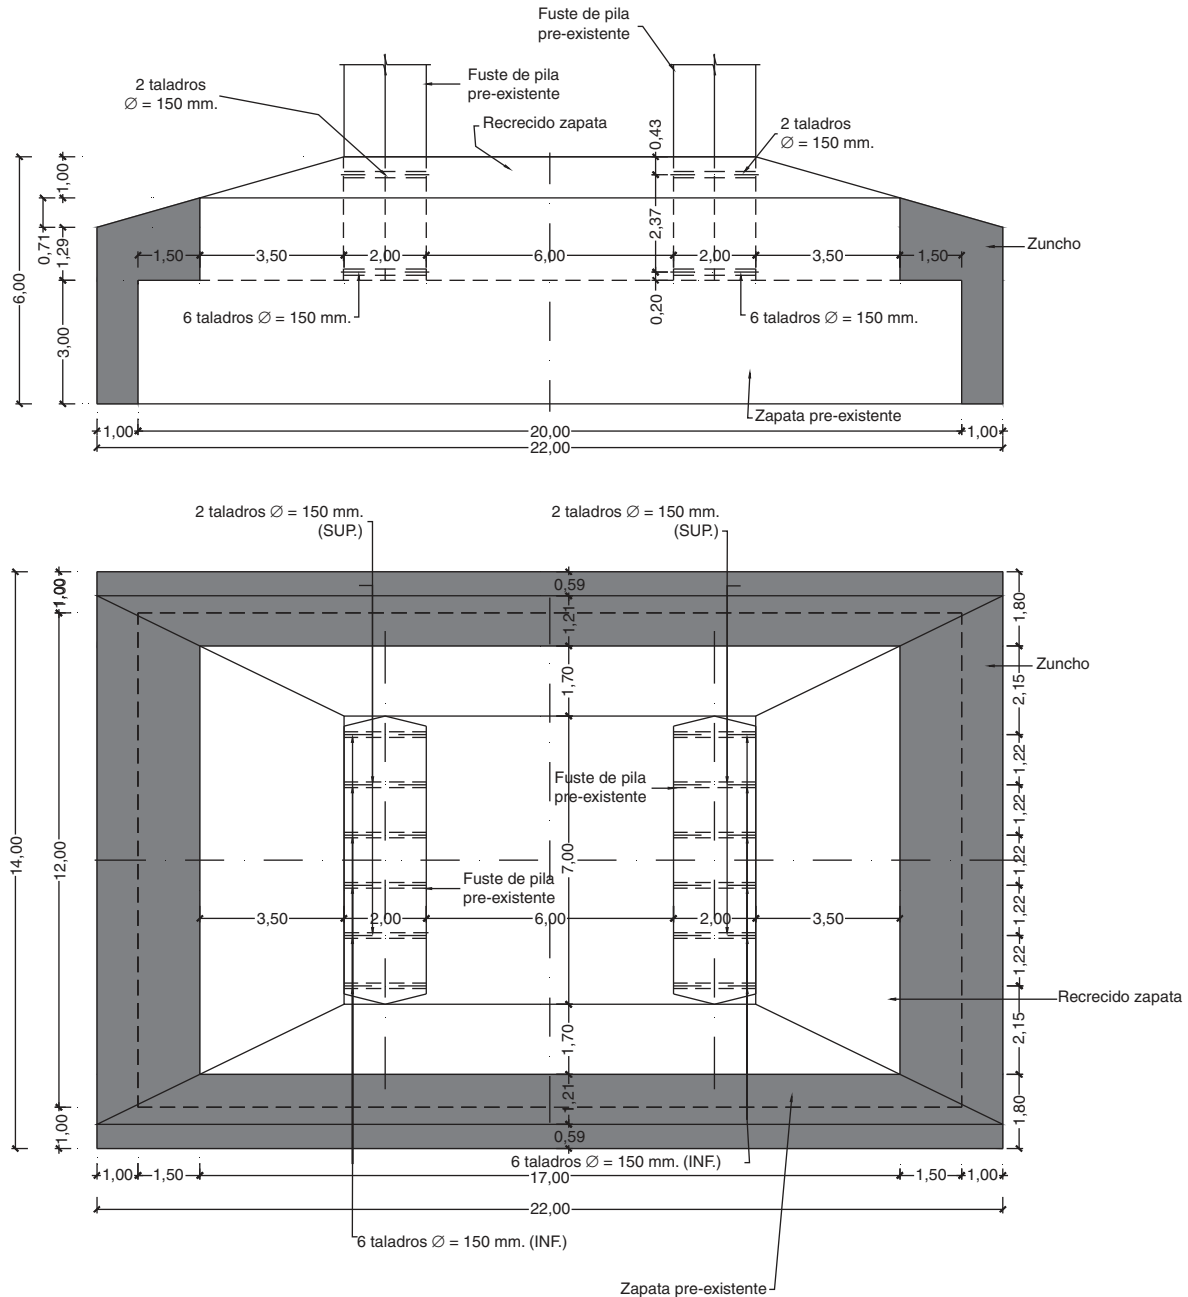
Zuncho perimetral de zapatas de pilas 1 y 4.
